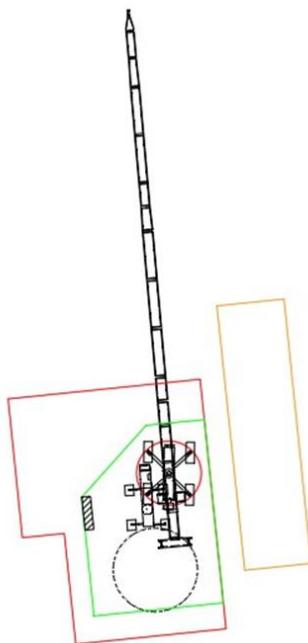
Vista dall'alto con Cabina di raccolta e gru da 200t
